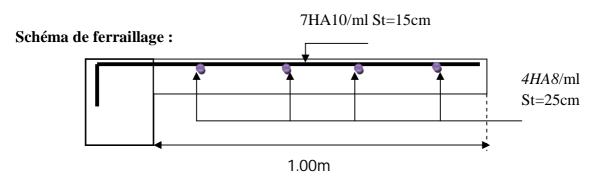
Schéma de ferraillage de 1^{er}type de dalle.
